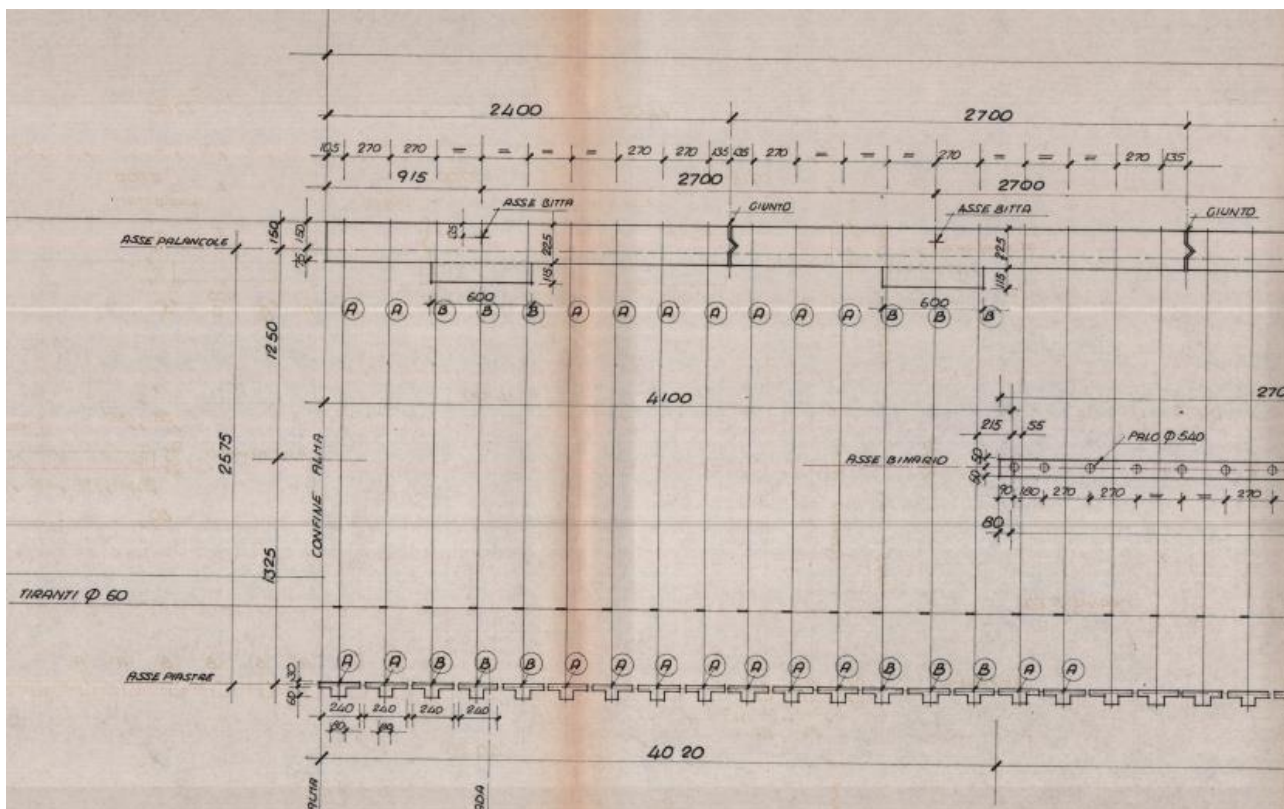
Stralcio planimetrico del banchinamento (dal progetto del 1977)
